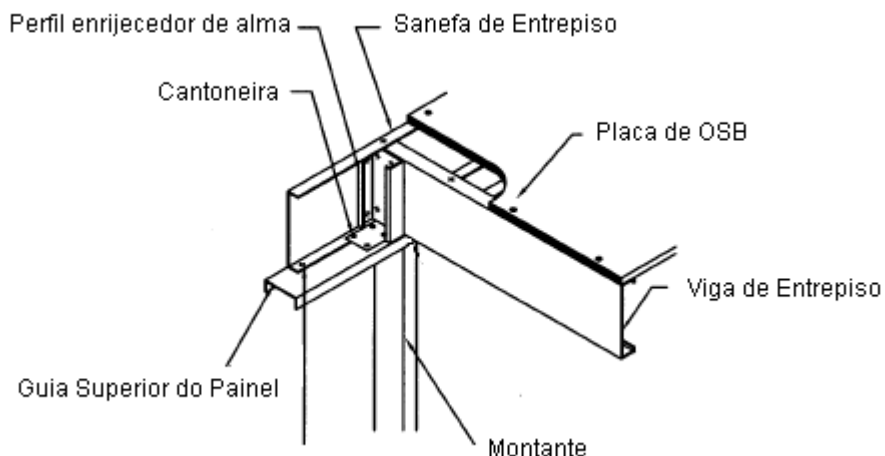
Detalhe construtivo da ligação dos perfis das vigas de entrepiso ao painel de parede.
